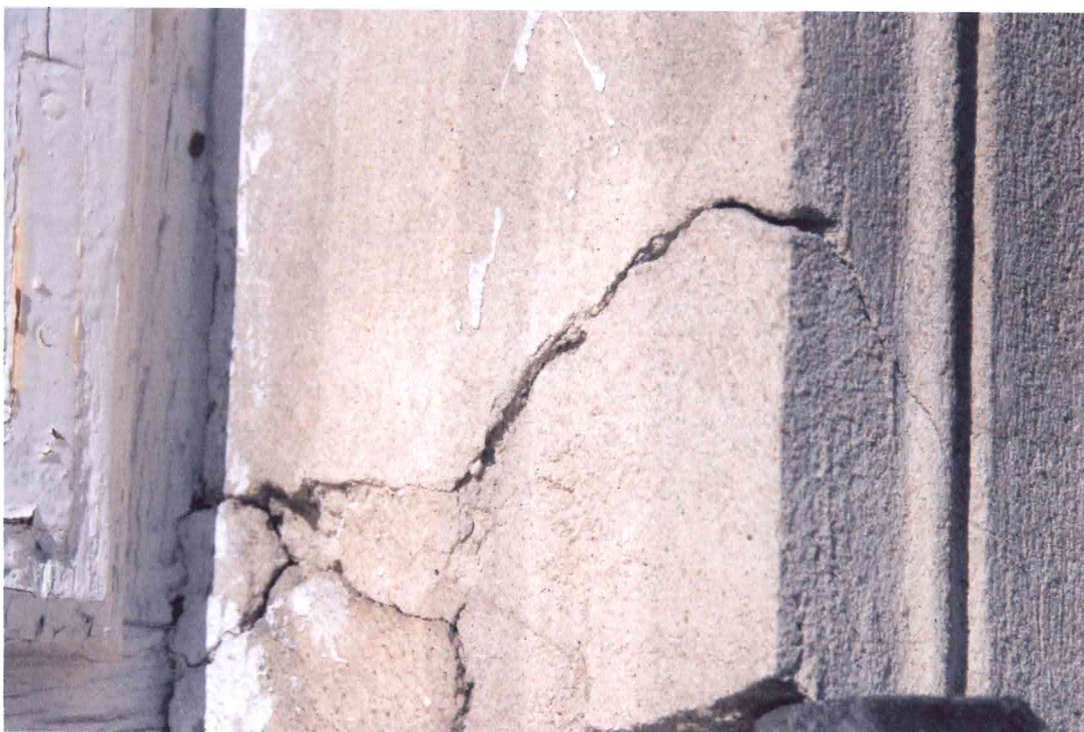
Radzyń Podlaski, Pałac Potockich, skrzydło wschodnie, elewacja wschodnia, fragment, stan przed konserwacją, październik 2008 r.
